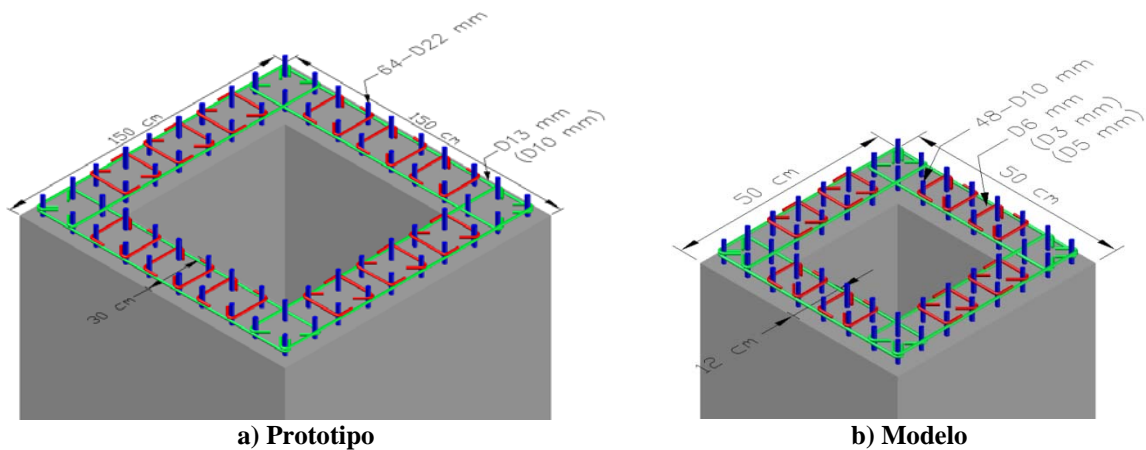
Sección transversal y configuración del refuerzo estudiado por Yeh et al. (2002a)
